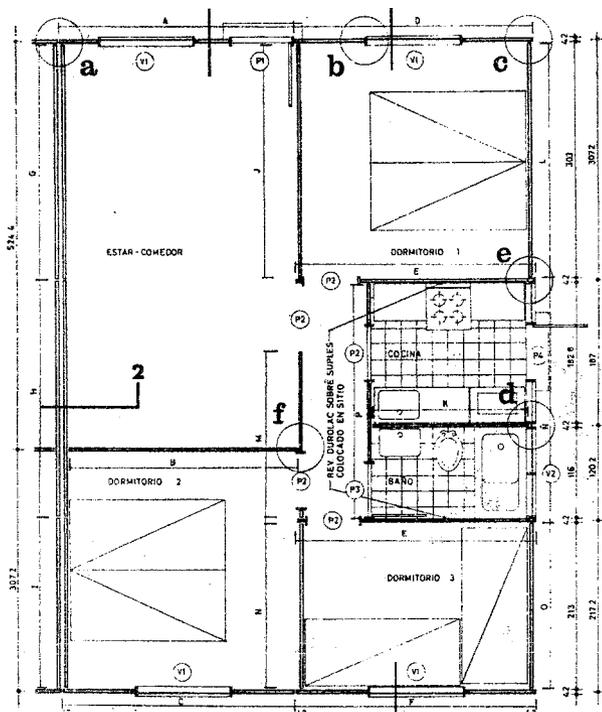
Sistema de prefabricación parcial, cuyos muros y tabiques están constituidos por paneles estructurales, contruidos con tablones machihembrados de pino.
